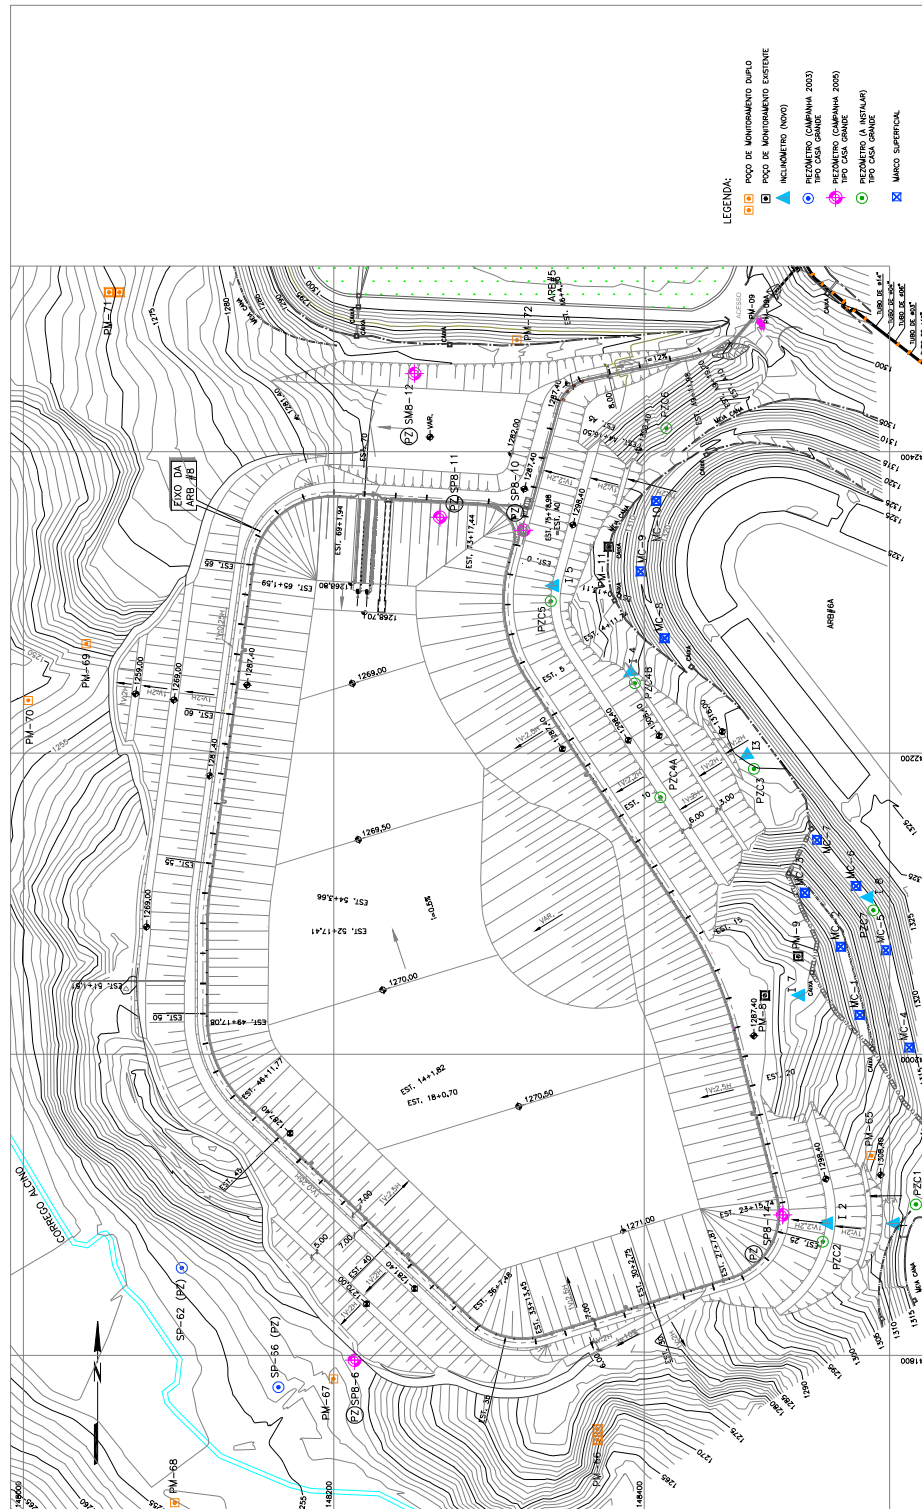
Planta de locação dos instrumentos para monitoramento da ARB 8 (LPS, 2005d).
